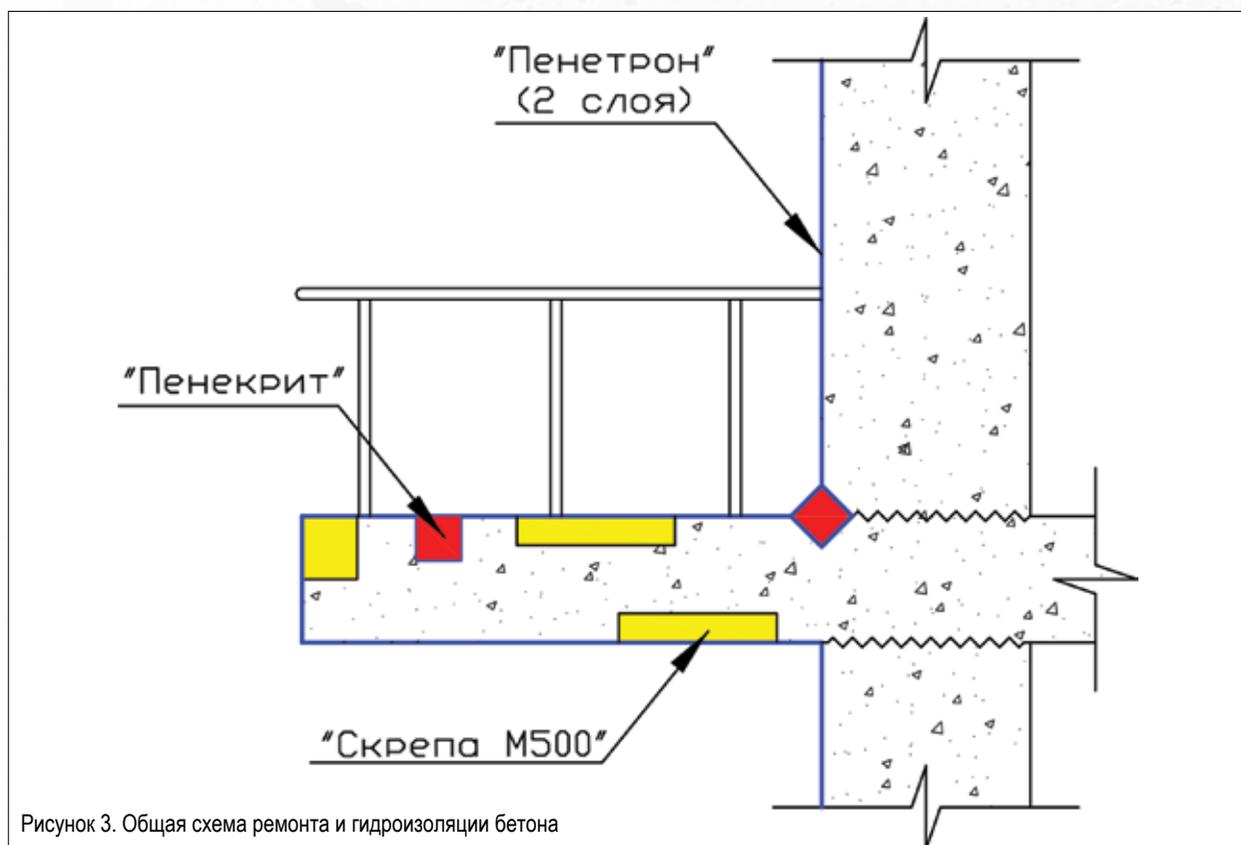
Общая схема ремонта и гидроизоляции бетона
